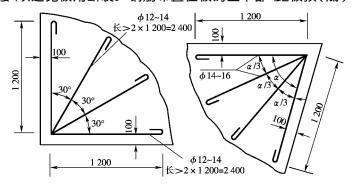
角隅钢筋布置(尺寸单位 mm)
